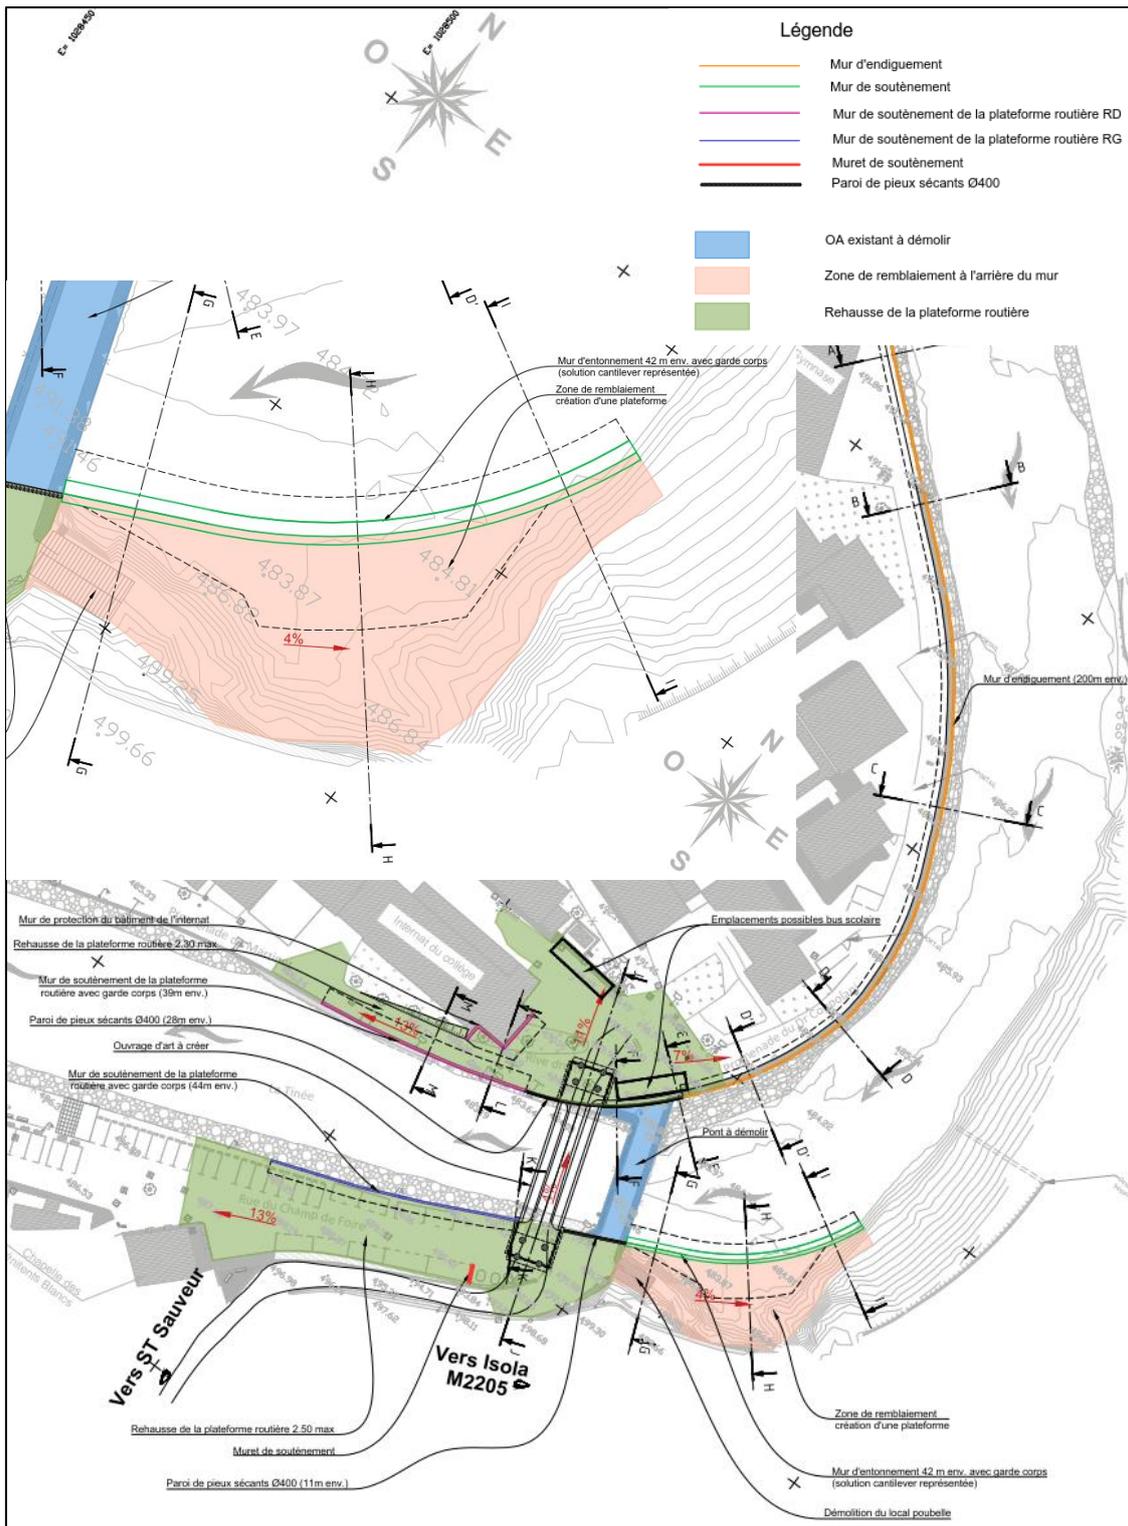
Vue en plan générale du projet avec entonnement et détail (extrait de l'AVP)
